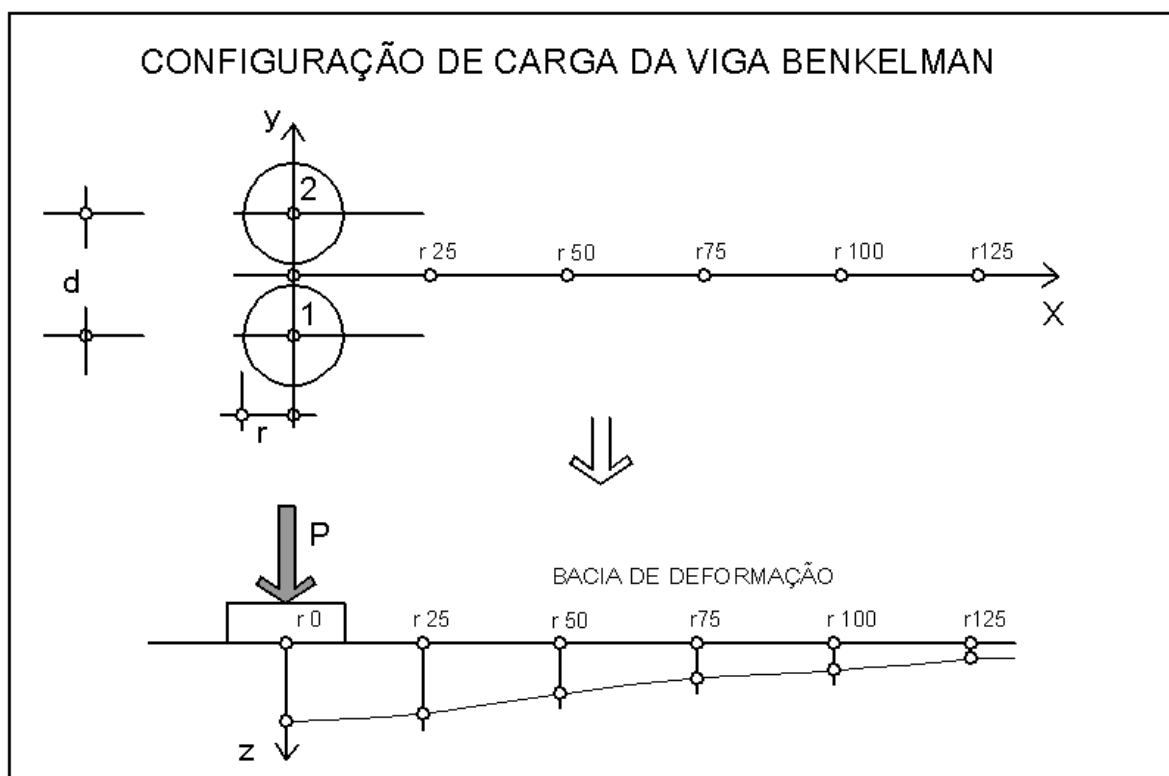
Pontos de Avaliação da Viga Benkelman.
